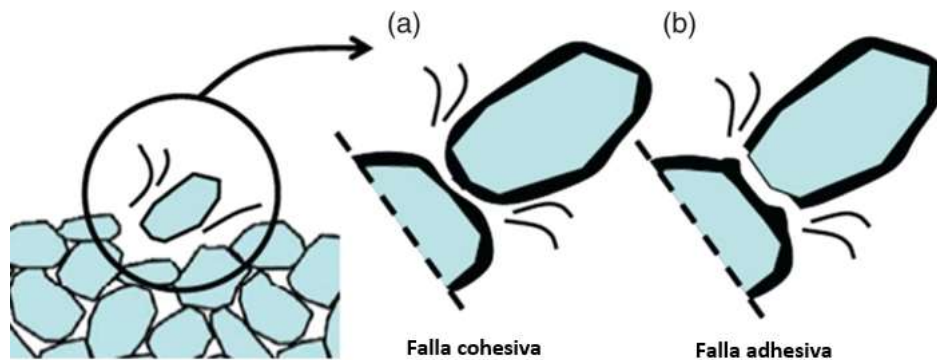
Falla cohesiva y adhesiva en la superficie del concreto asfáltico (Kringos, 2007)
